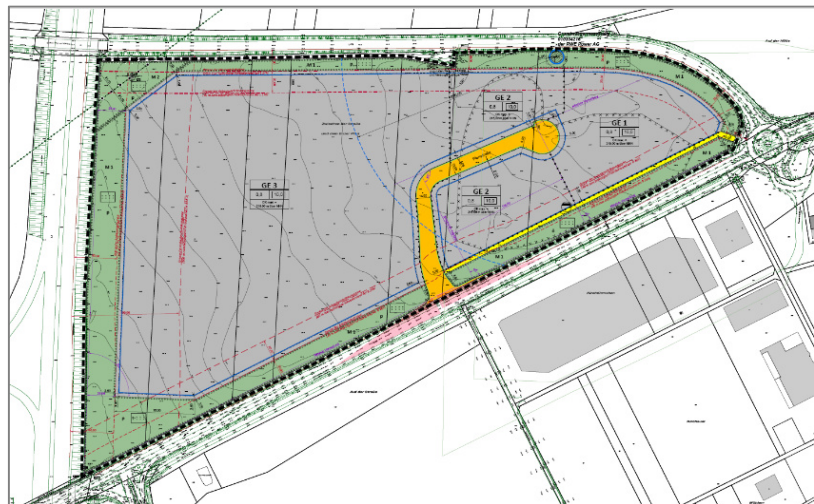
Planvorgabe, Bebauungsplan Nr. 5
